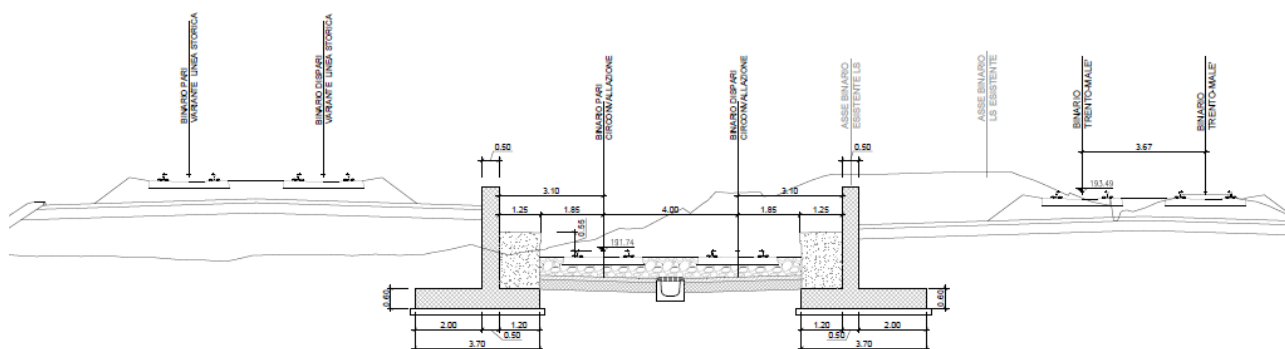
Sezione trasversale tra i muri in c.a. TR04
